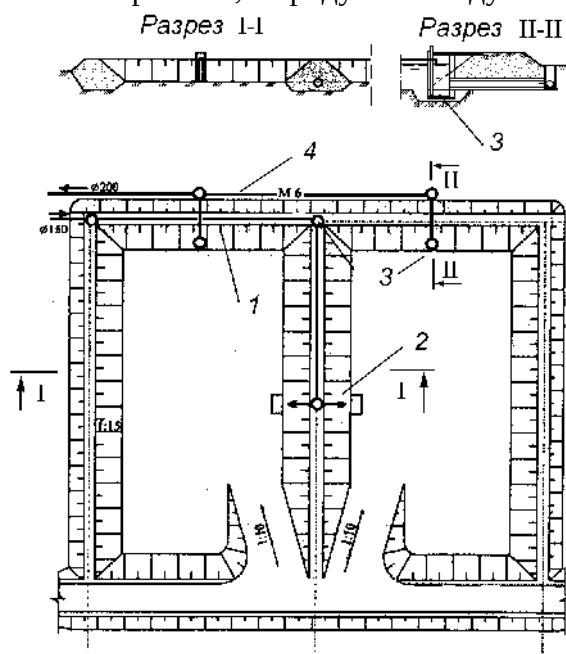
Иловые площадки на естественном основании без дренажа с поверхностным отводом иловой воды:
